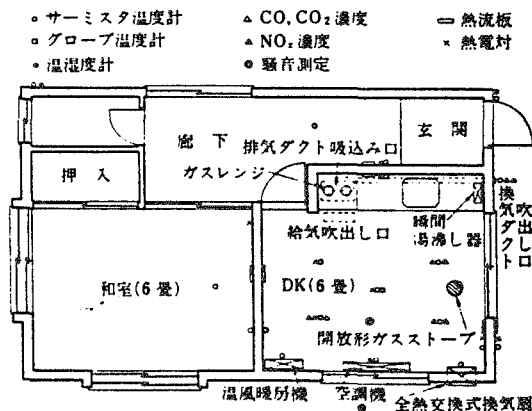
防音実験住宅平面図および測定点位置図(DKの室容積は約 23 m^3)
